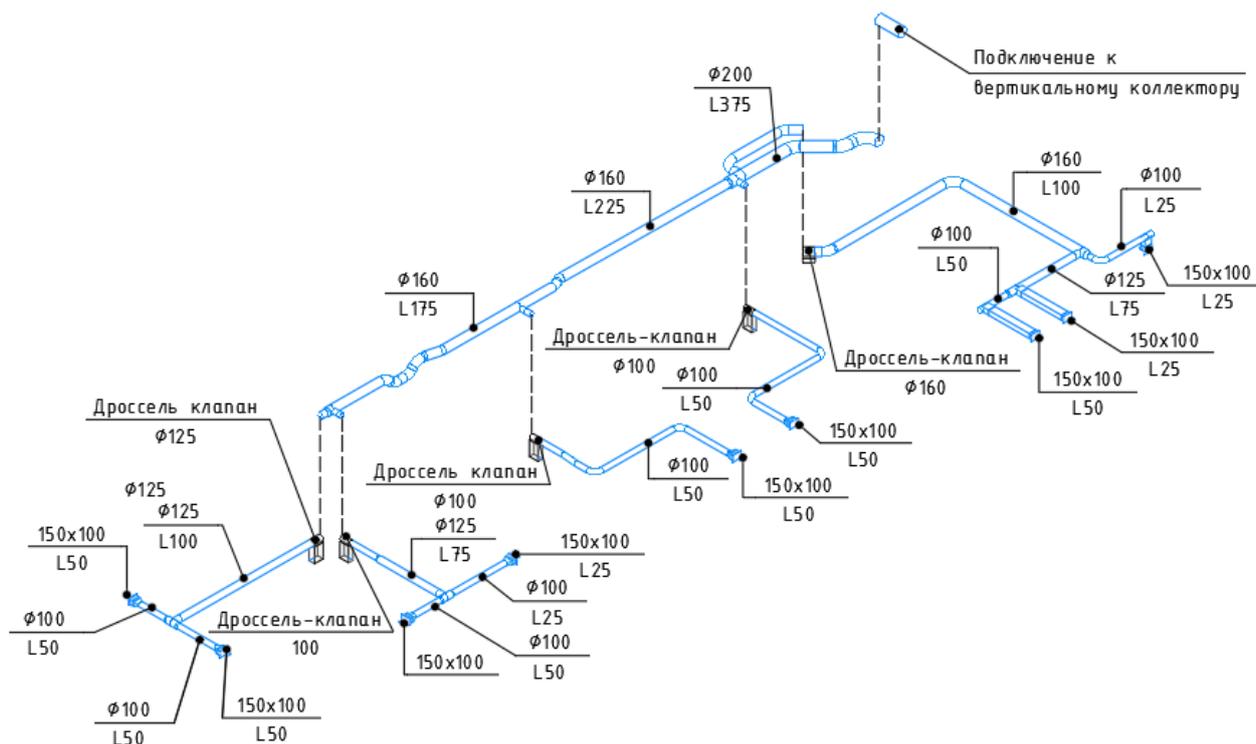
Схема вытяжной вентиляции на типовом этаже высотного жилого здания. Подключение поквартирных ответвлений к сборному воздуховоду
